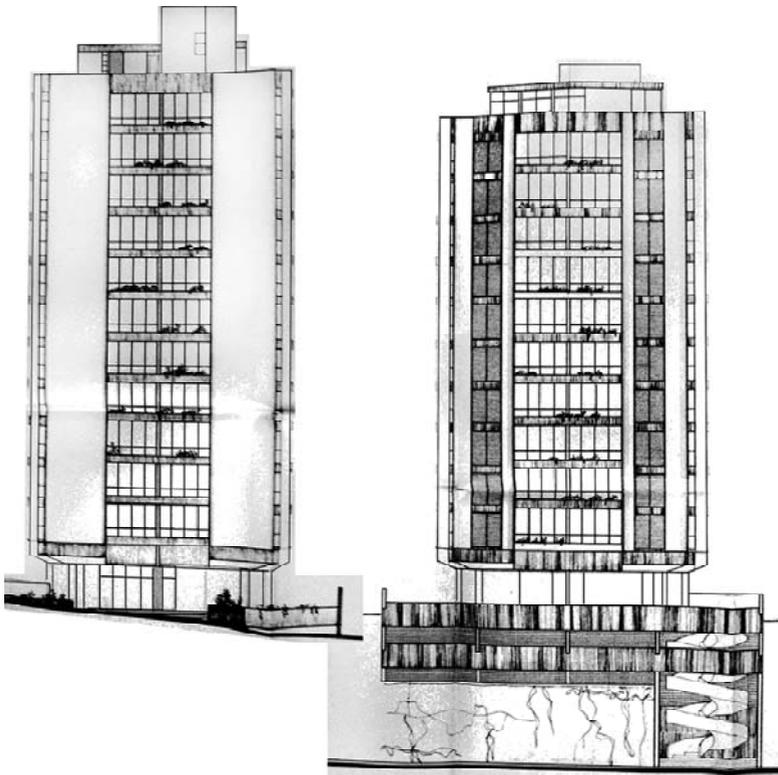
a- fachada Sul do Gemini II e b- fachada Norte do Gemini I.
